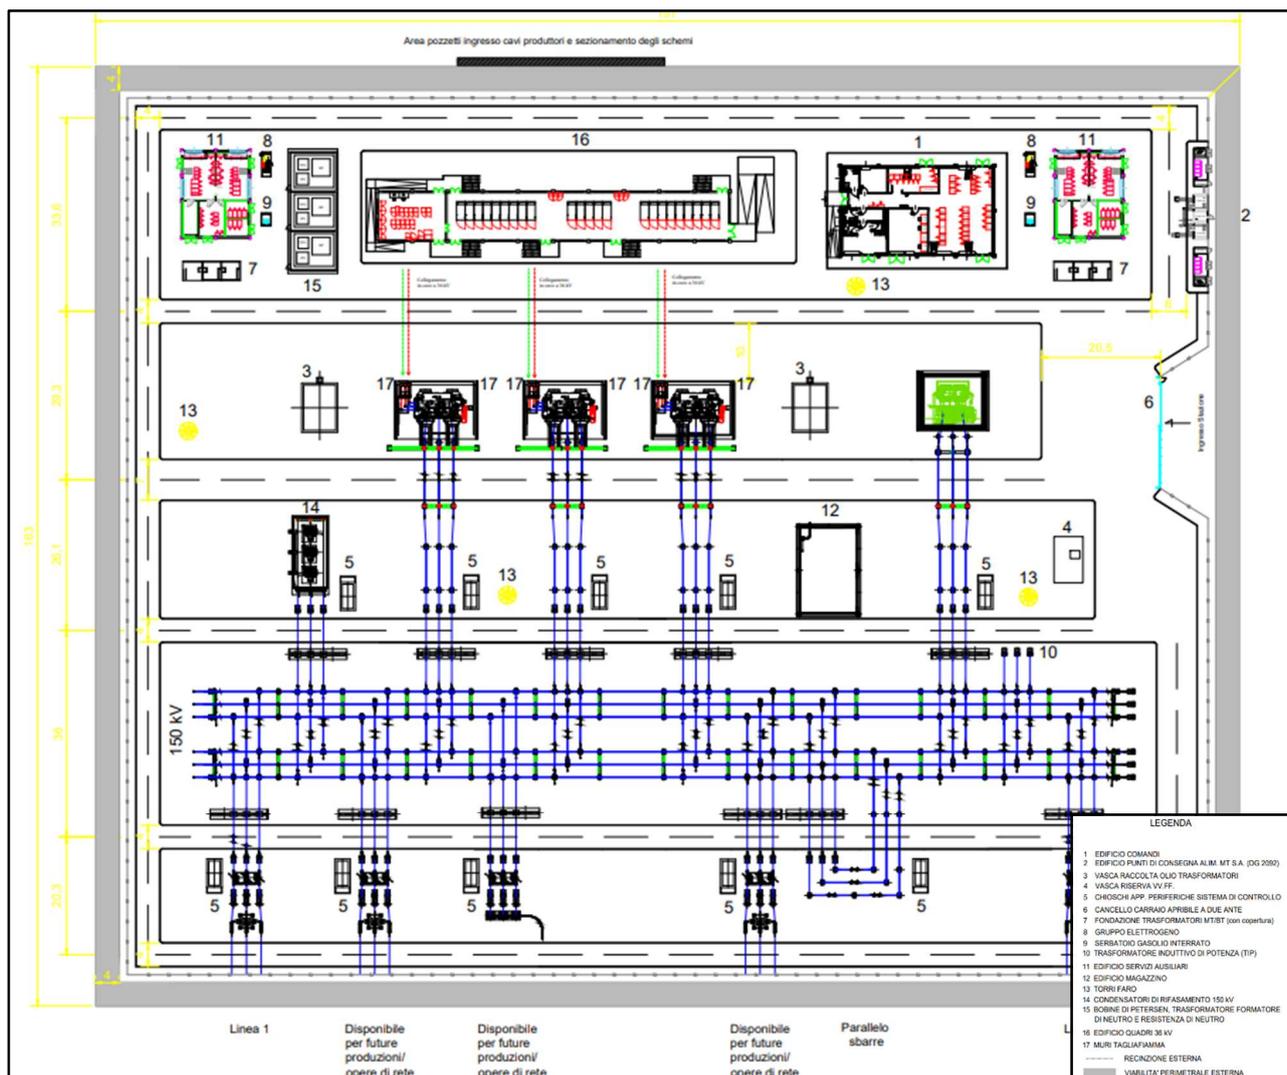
Planimetria elettromeccanica della SE RTN
